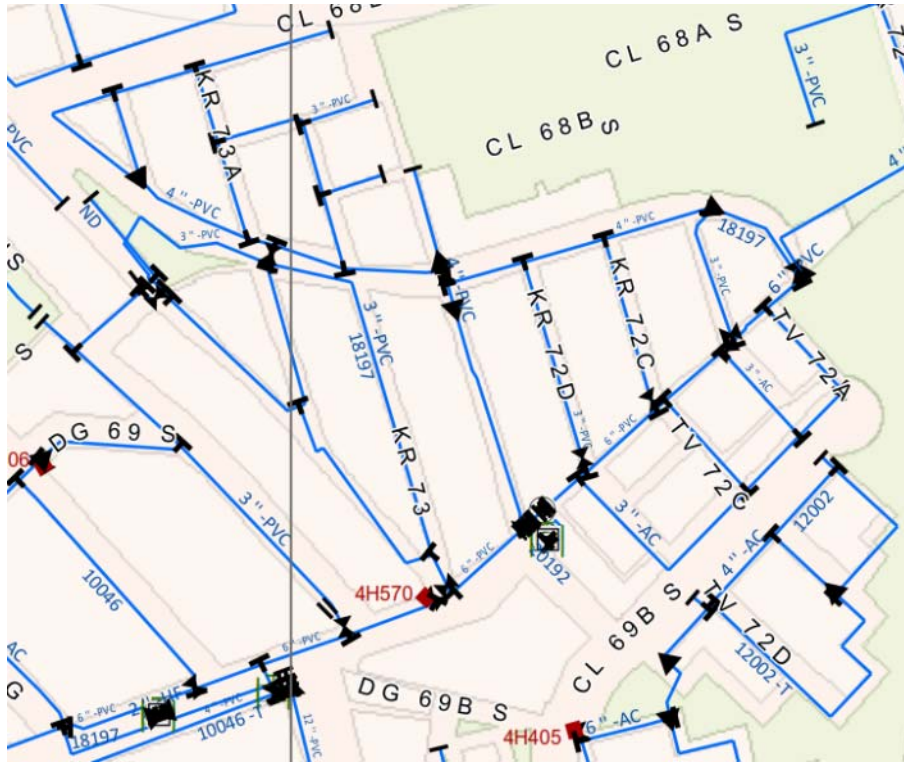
Red de Acueducto en la zona de estudio. Fuente: Plancha 246-II-B-2 suministrado por la Empresa de Acueducto y Alcantarillado de Bogotá – EAAB. 2018.
